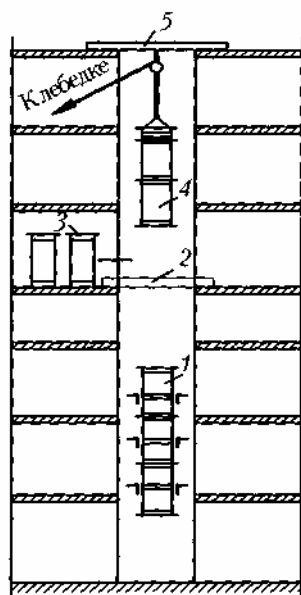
Монтаж вертикальных воздуховодов методом наращивания сверху: 1 — воздуховоды на кронштейнах; 2 — настил; 3 — звенья воздуховодов; 4 — монтируемый блок; 5 — грузовая балка
